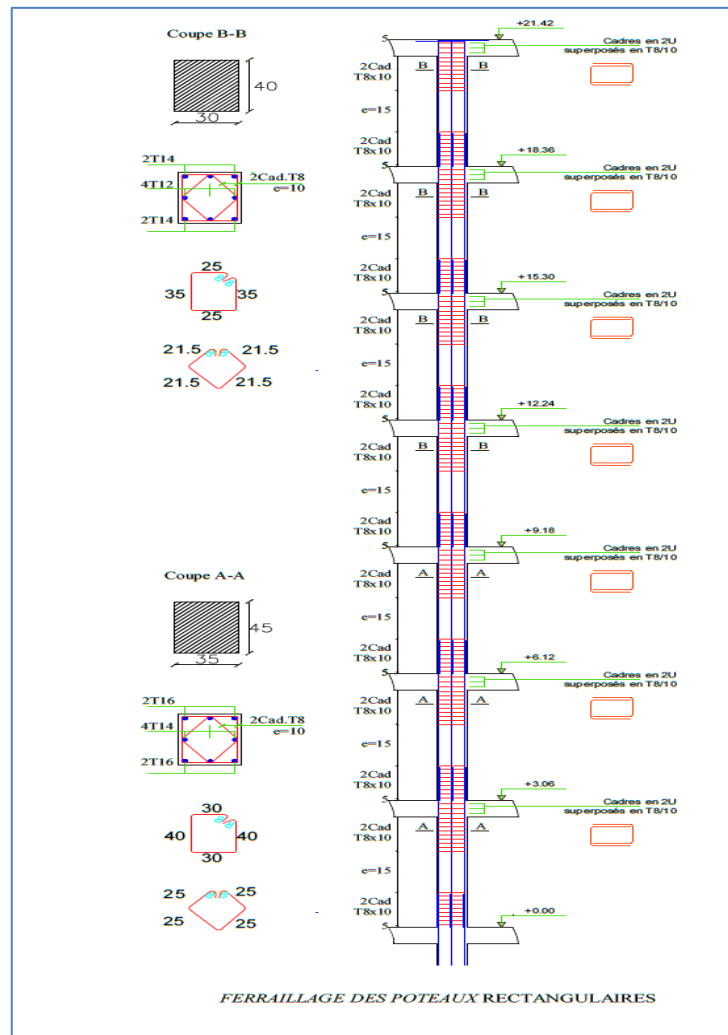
dessin ferrailage de poteau rectangulaire
